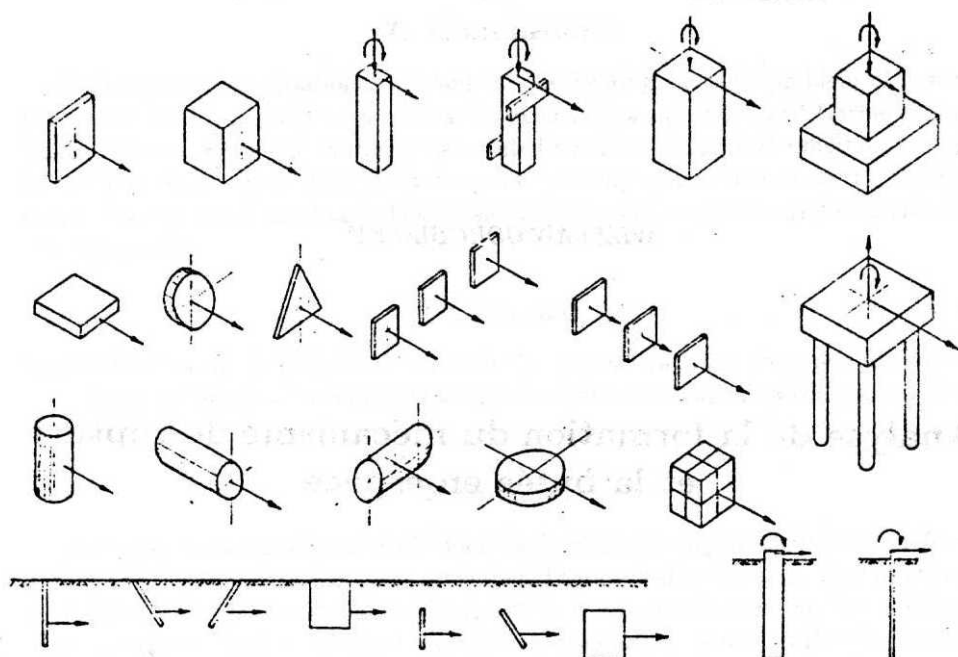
Exemples des éléments et des ensembles des fondations soumises à des forces horizontales-plaques et blocs d'ancrage avec formes diverses qui travaillent isolément et comme un ensemble, fondations des poteaux, fondations de blocs, pieux isolés et fondations sur pieux
